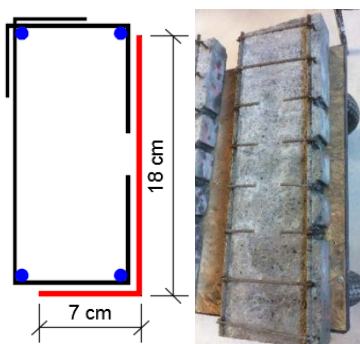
Recuperação do modelo 6. Corte da face lateral do pilar para ancoragem do estribo com o grauteamento e amarração com arame recozido. Fonte: Autor, 2017.
